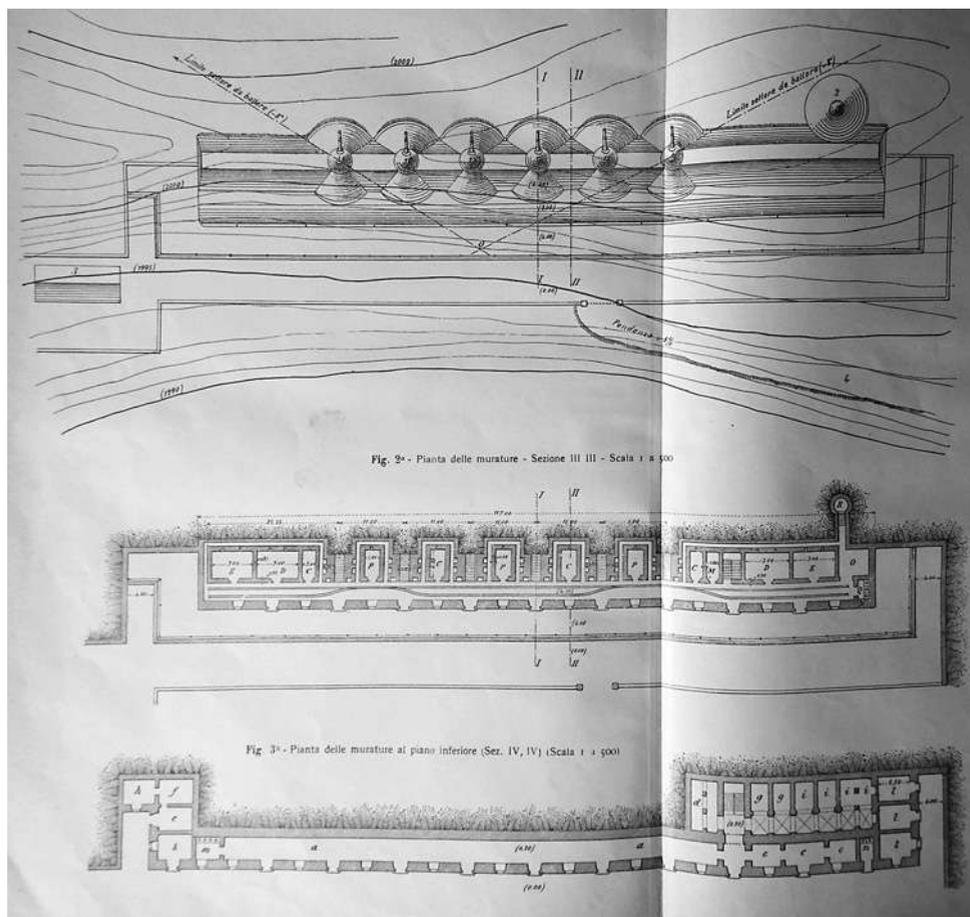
Esempio di forte di sbarramento con le artiglierie in pozzi, pianta e sezioni (da Guidetti *La fortificazione permanente*, cit., tav. 36).
